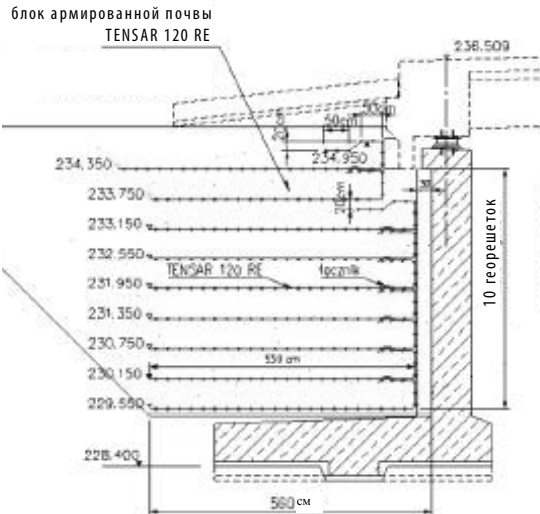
Блок из армированного грунта за подпорной стеной. Autostrada A4, отрезок Сосница-Вирек [8]
